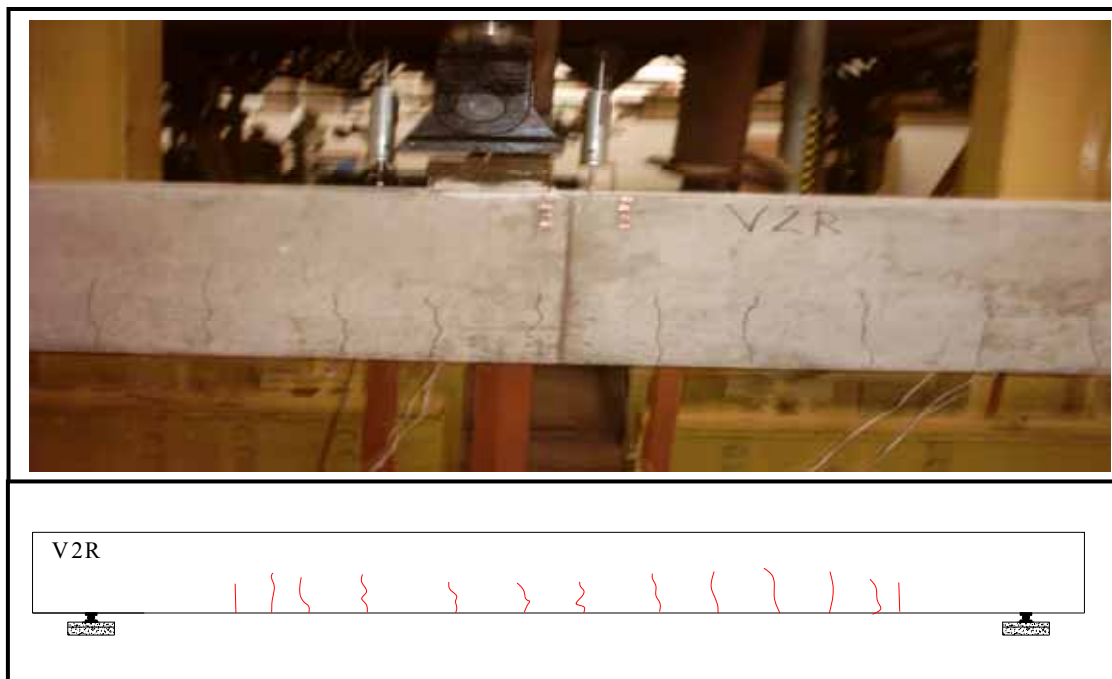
Viga V2R depois do ensaio de pré-fissuração.
